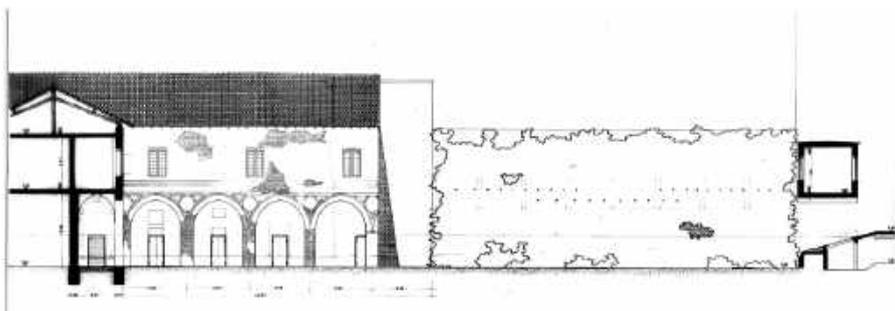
Sezione del chiostro nord, progetto di restauro
